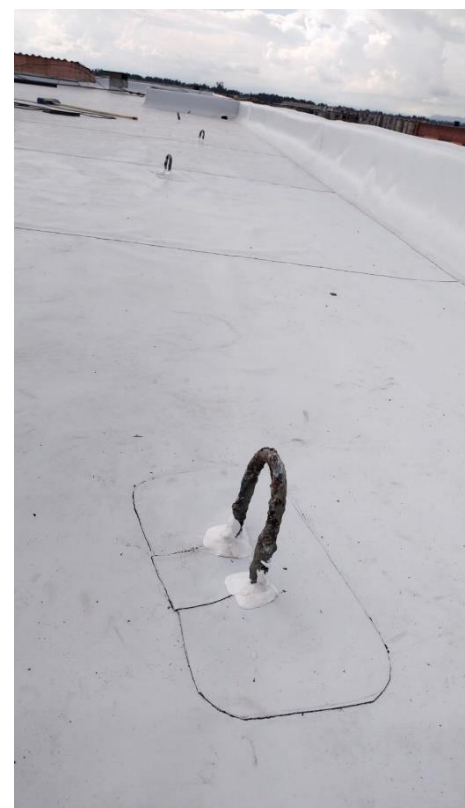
Instalación geotextil y membrana PVC en placa (Porvenir)
